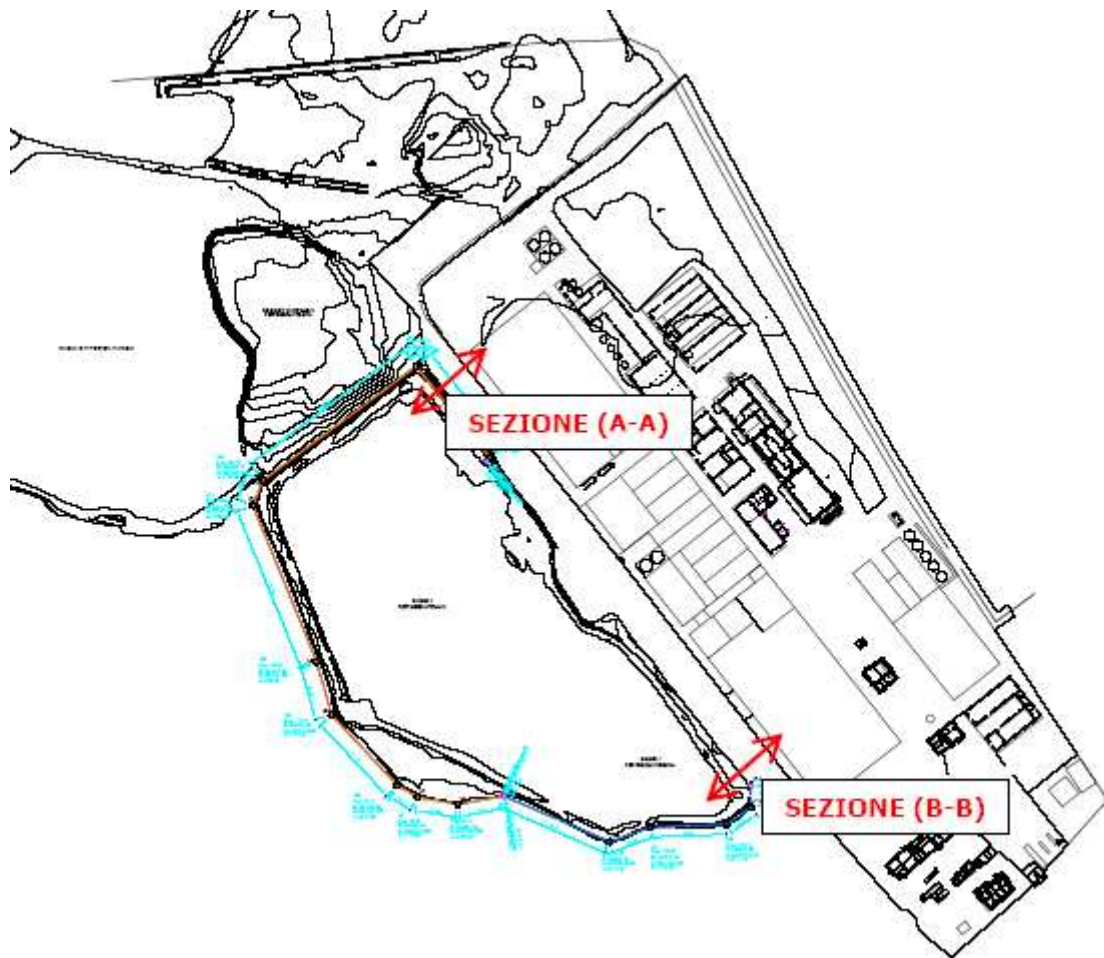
individuazione planimetrica delle sezioni di analisi.
